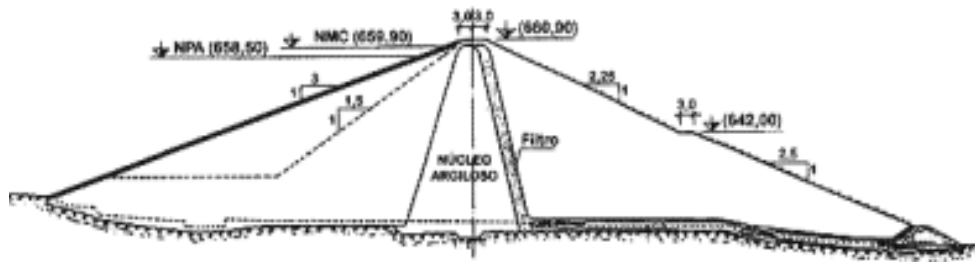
Barragem de perfil zonado de Alijó, Portugal (Adaptado de Melo, 2016).
